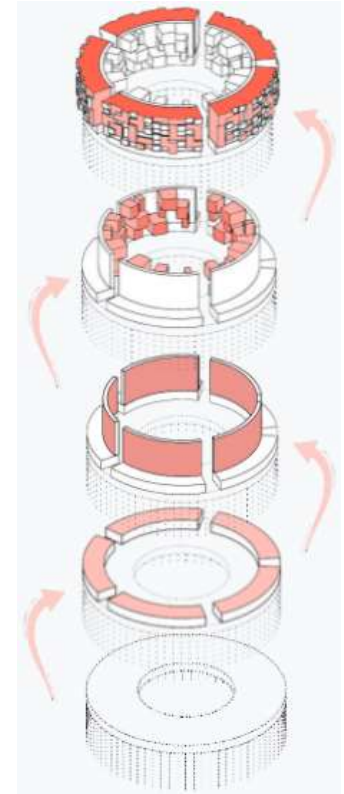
, Proceso de diseño Tiegen Dormitory. [Figura]. Recuperado de: Galería Tiegen Dormitory/Lundgaard & Tanberg Architects - 1(archdaily.co)
